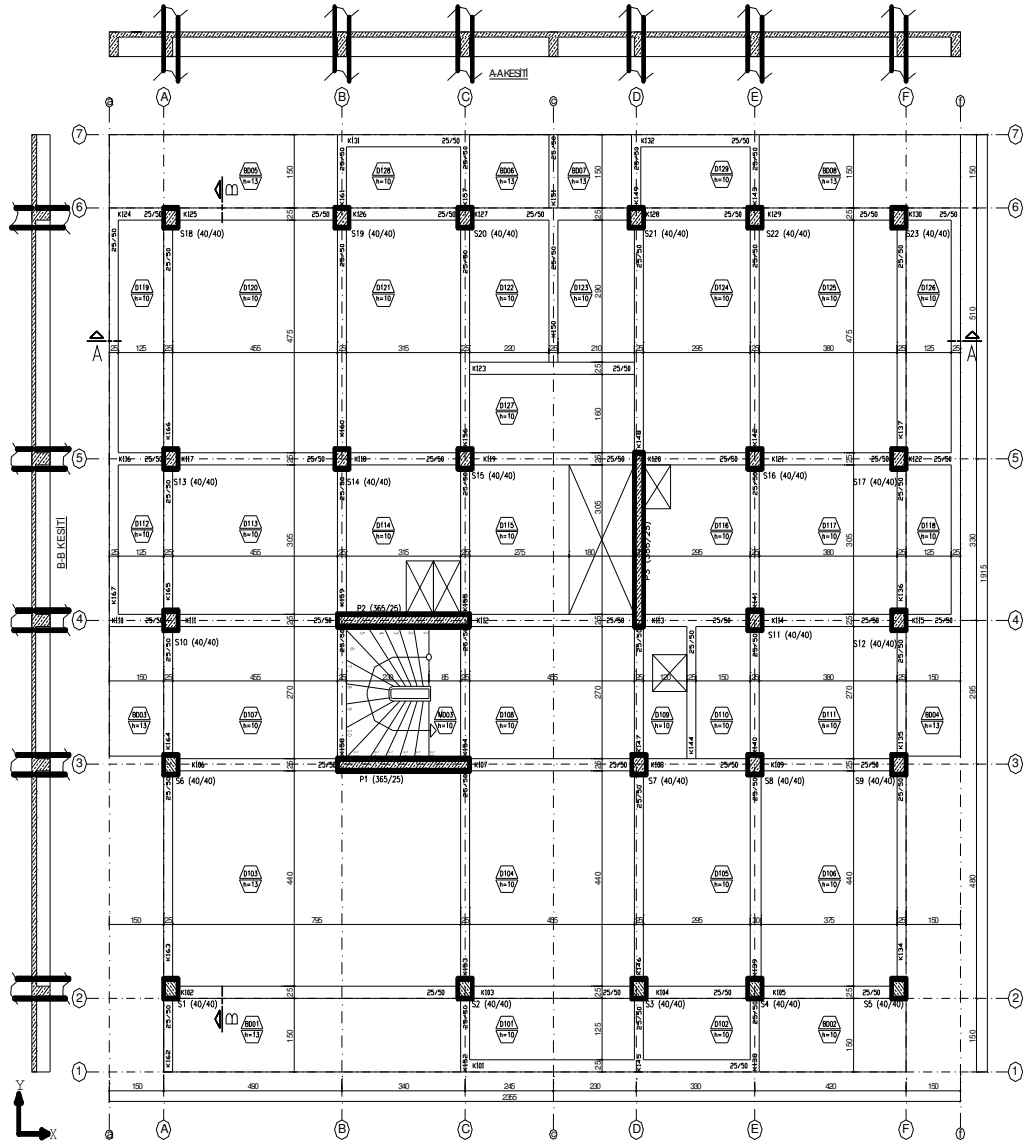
Örnek olarak seçilen planda simetrik dört katlı betonarme yapıya (BY1-4) ait kalıp planı
